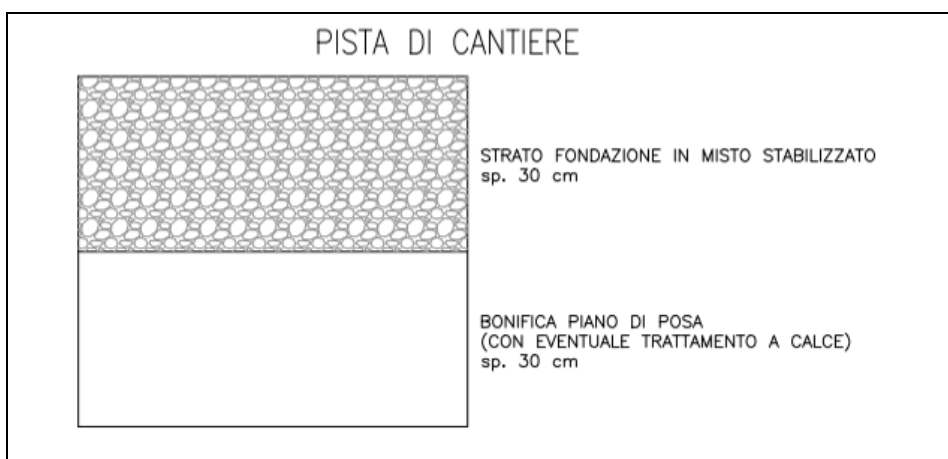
Schematizzazione del pacchetto stradale per la realizzazione delle piste di cantiere in ambito agricolo.
